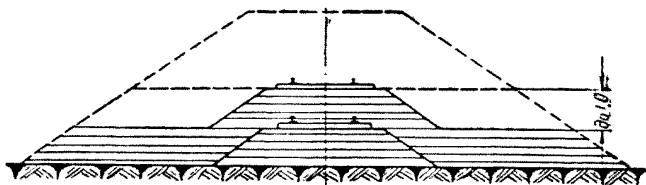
Послойная отсыпка грунта с укладкой рельсового пути по оси насыпи
